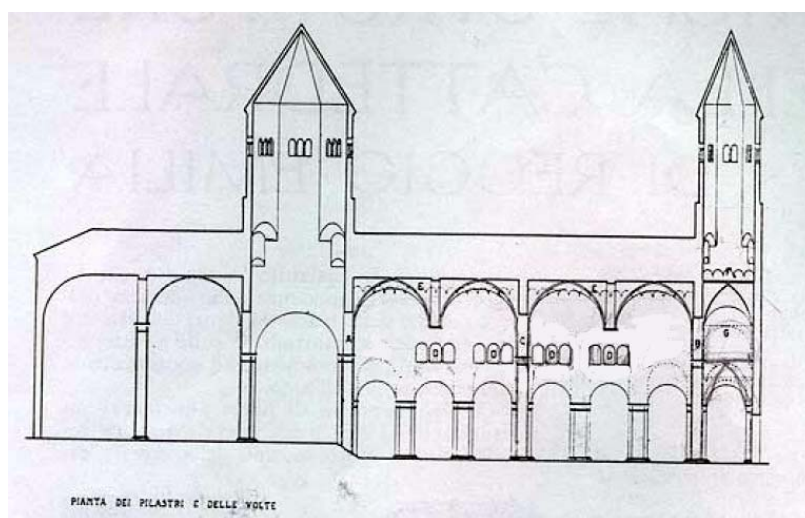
Sezione longitudinale, ricostruzione dell'alzato della chiesa di XIII secolo
